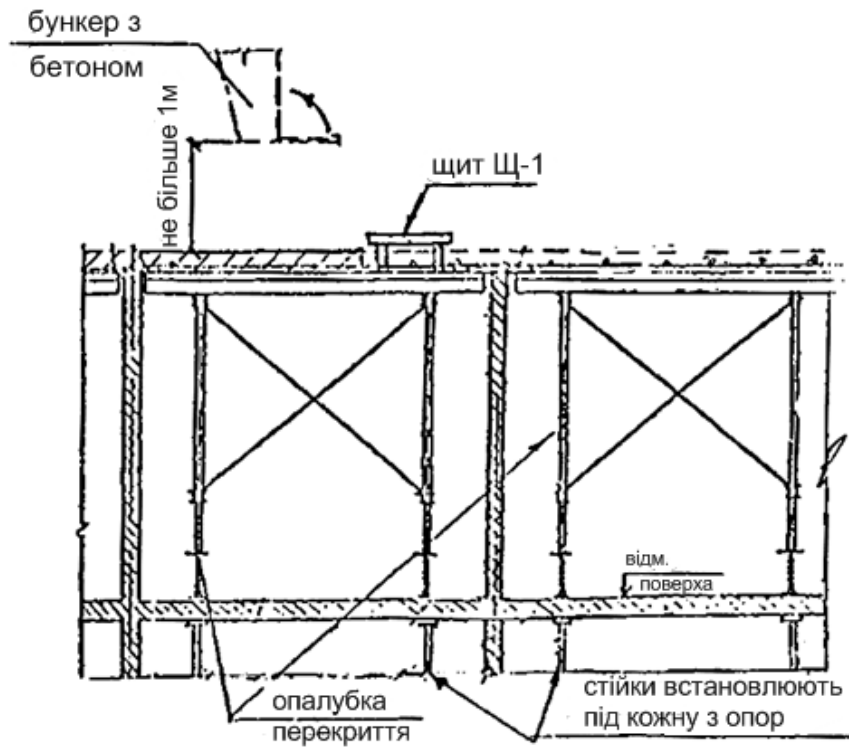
Вивантаження бетонної суміші з бункера в опалубку перекриття
